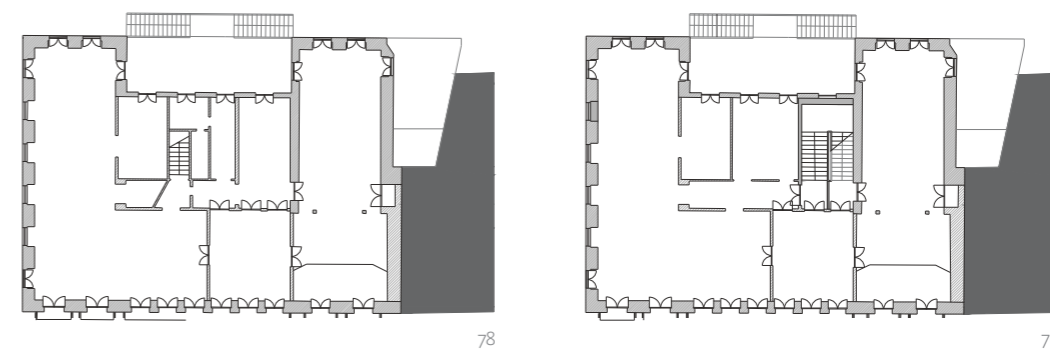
Planta do piso intermédio primitivo (1) à escala 1/500.
